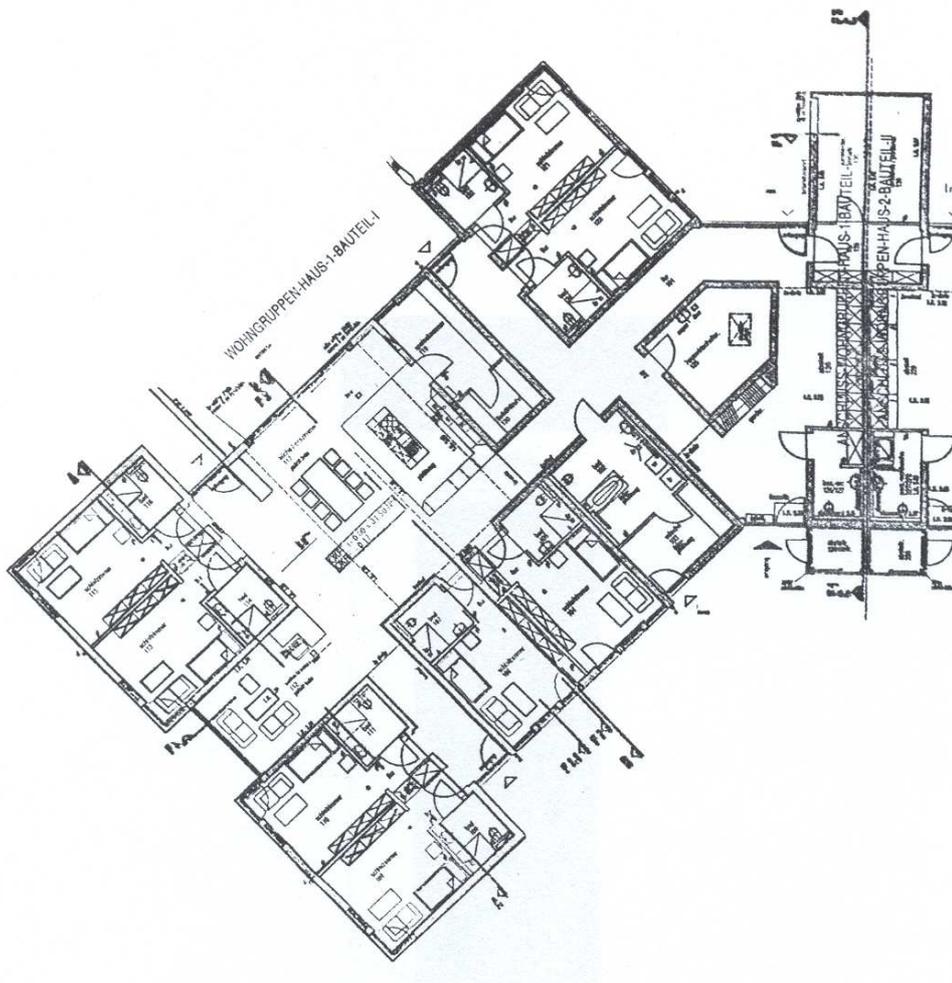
Grundrisszeichnung Hausgemeinschaft „Clara Zetkin“
